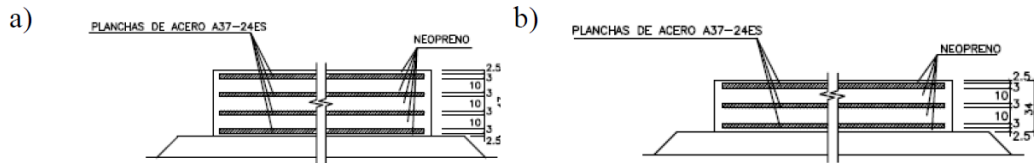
Apoyo elastoméricos a) estribos y b) cepa, Puente Chada [17].
